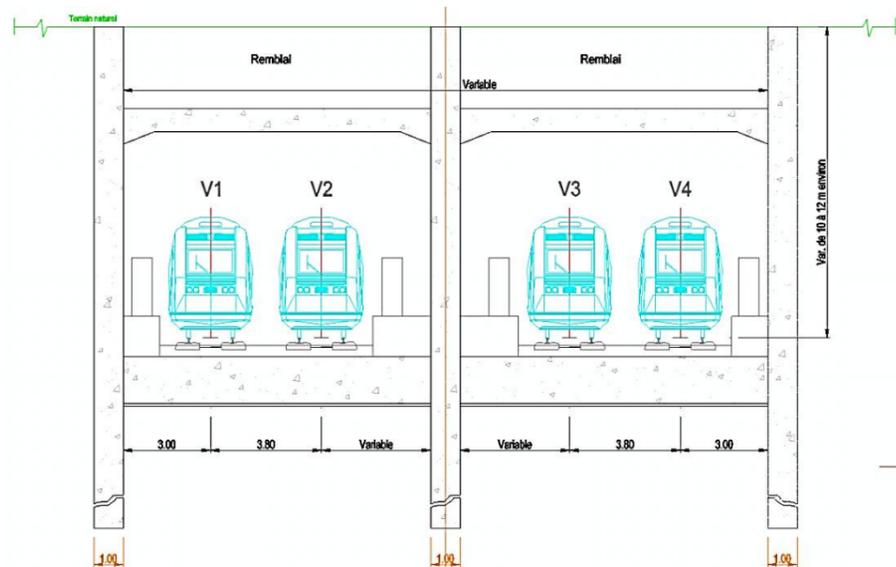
Coupe GC de la section courante de la traversée de Lesquin en TC à 4 voies (Coupe B-B)
